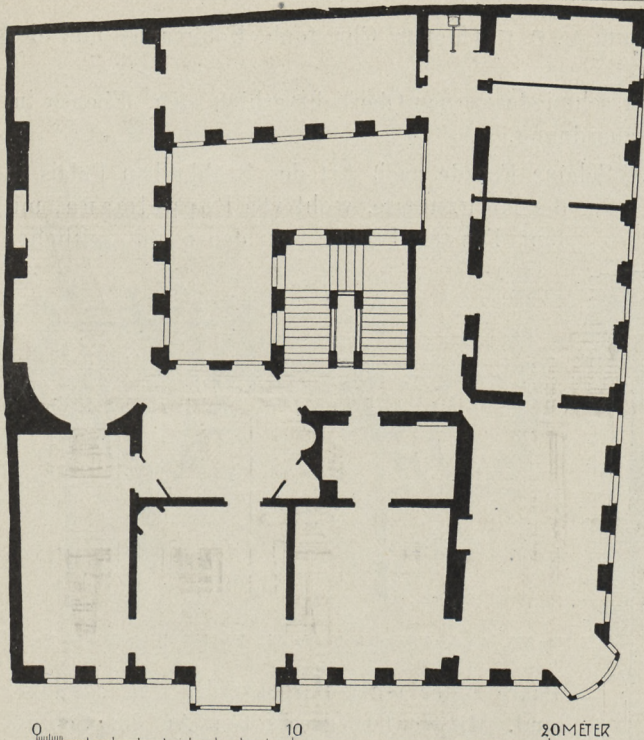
Kleine Brüdergasse Nr. 21. Grundriss des Obergeschosses.
